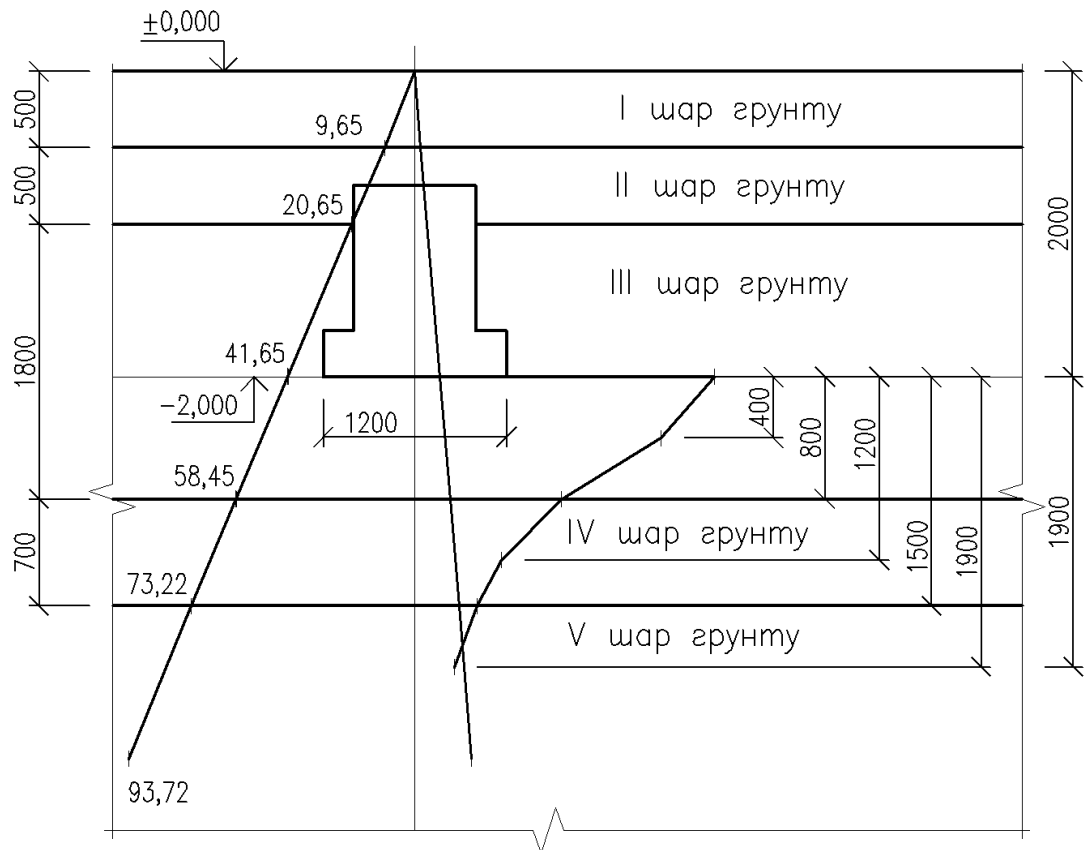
Ґрунтовий стан будівельного майданчика по ряду 1
